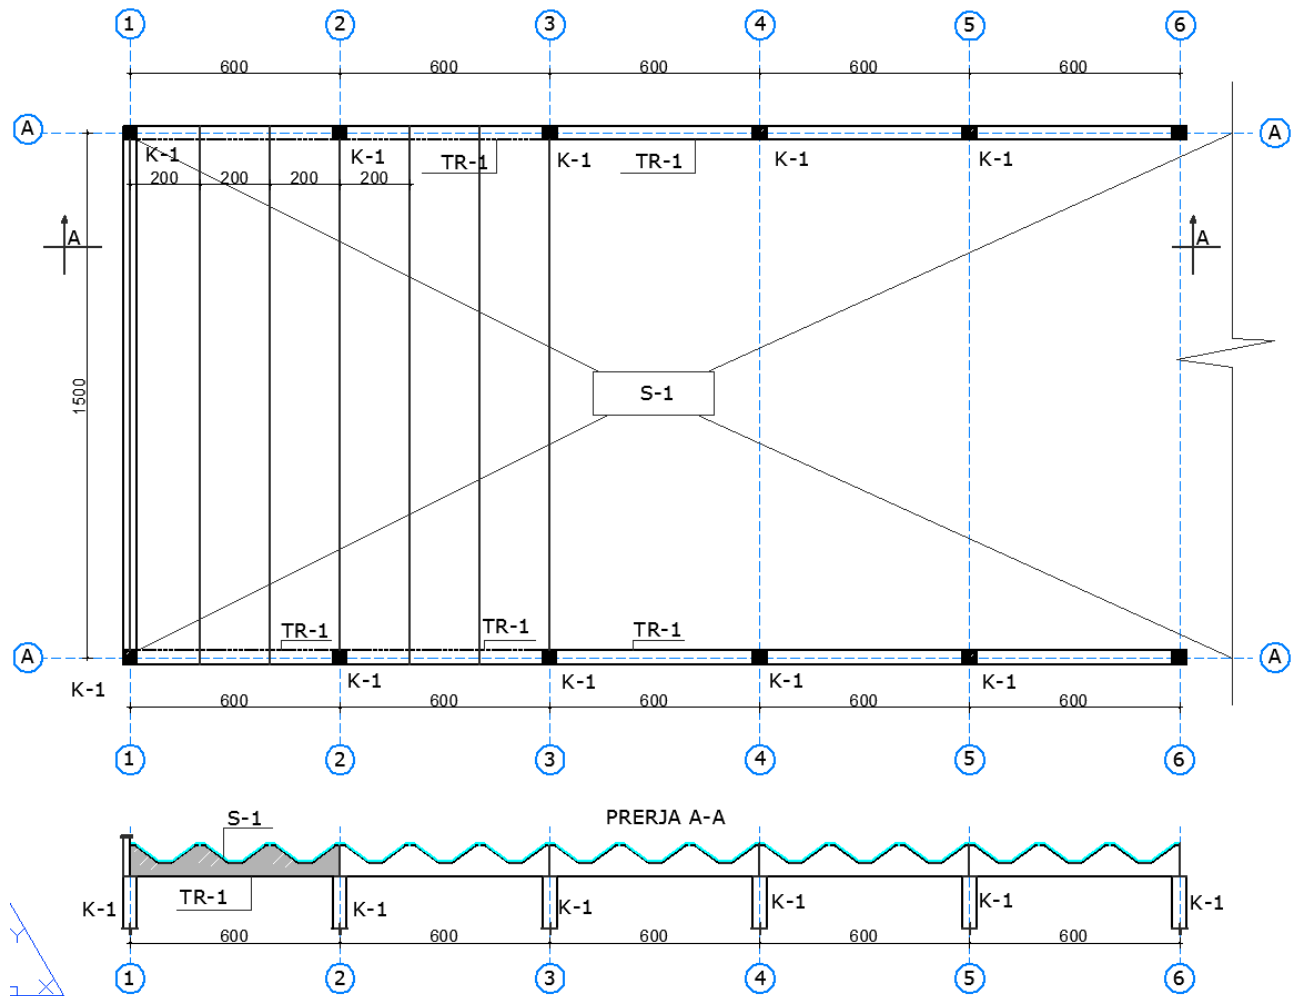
Plani i strukturave të mbulesës dhe prerja A-A
